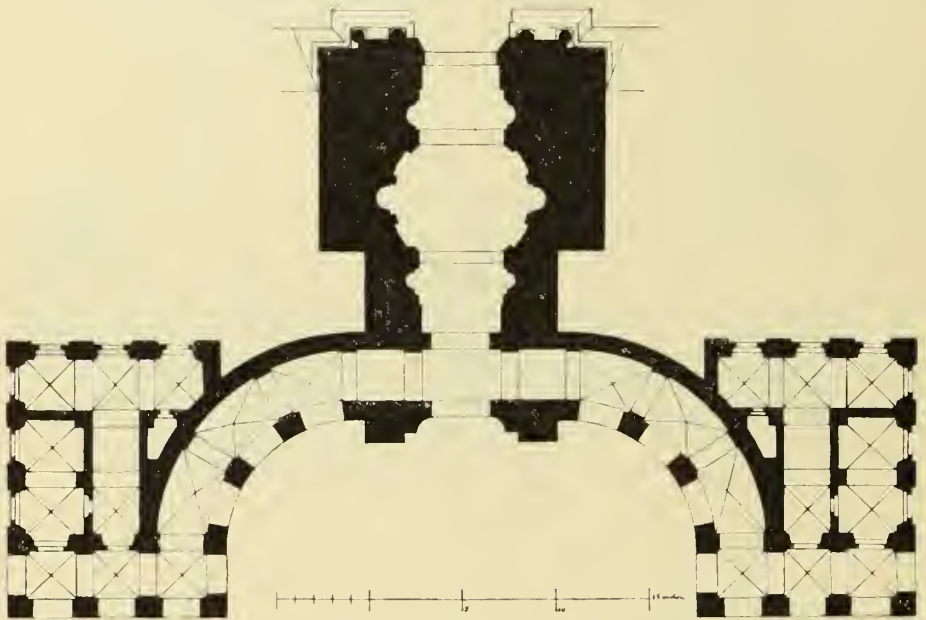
Wesel. Grundriss des Berliner Thores.
